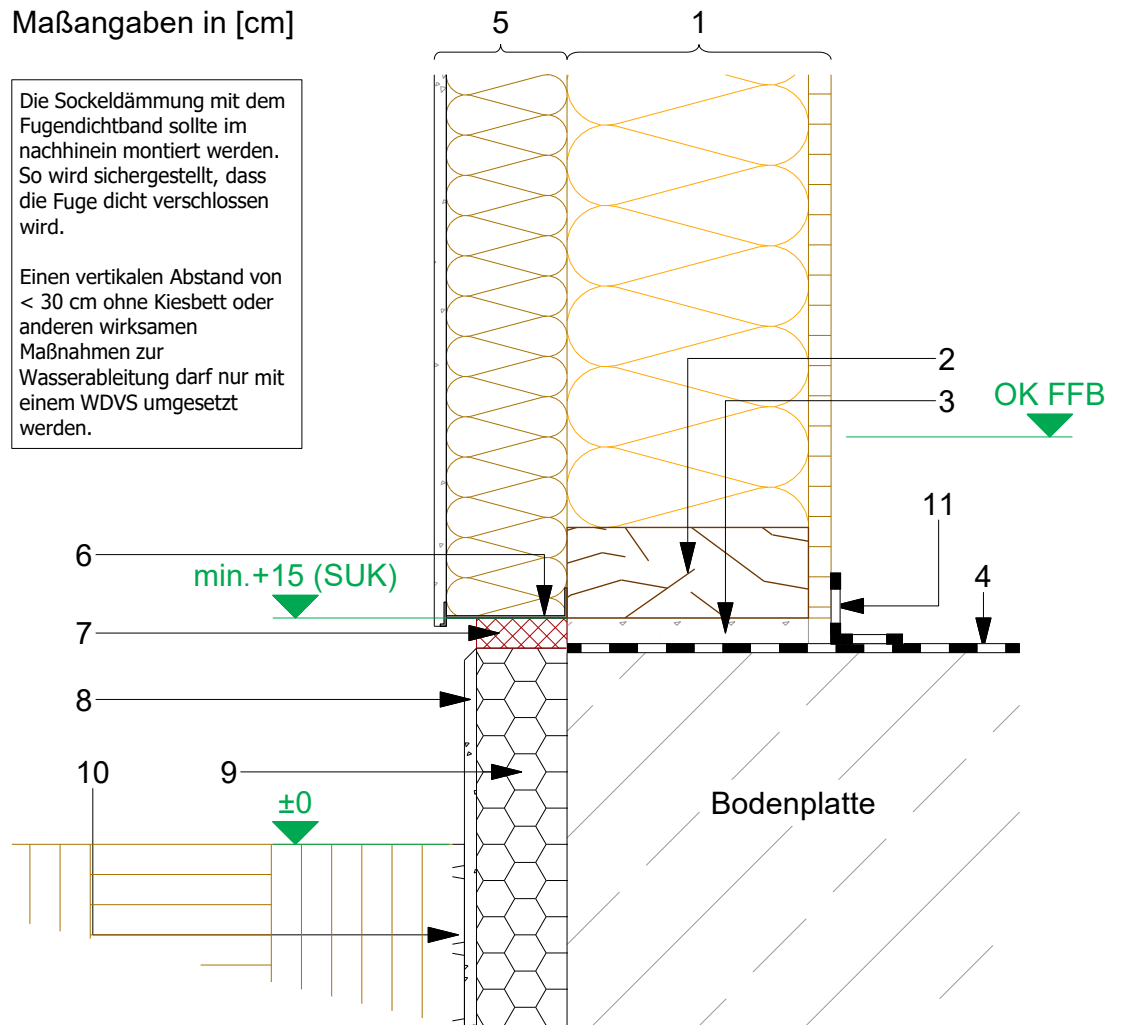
Schwelle über Spritzwasserbereich mit WDVS gemäß DIN 68800-2
